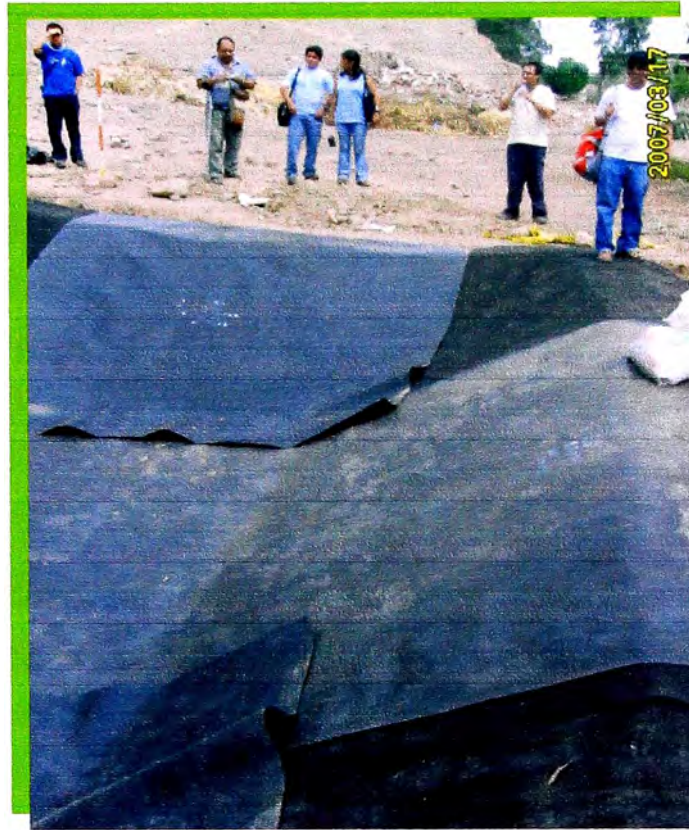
Tendido de paneles de geomembrana en la poza.
